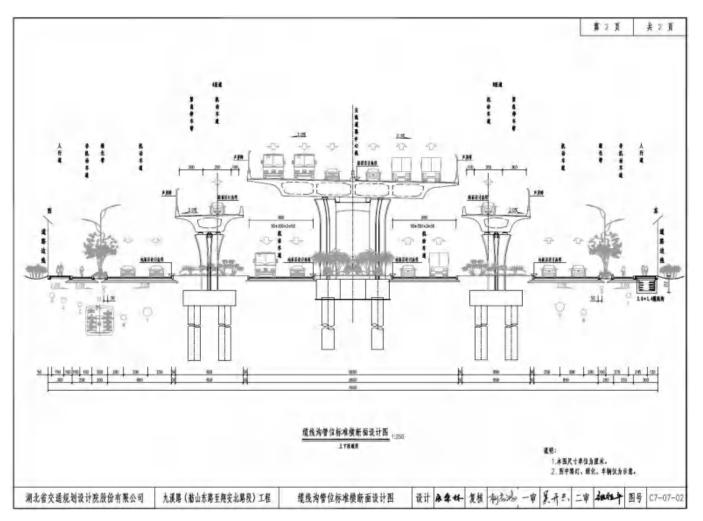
缆线沟管位标准横断面图 (上下匝道段)
